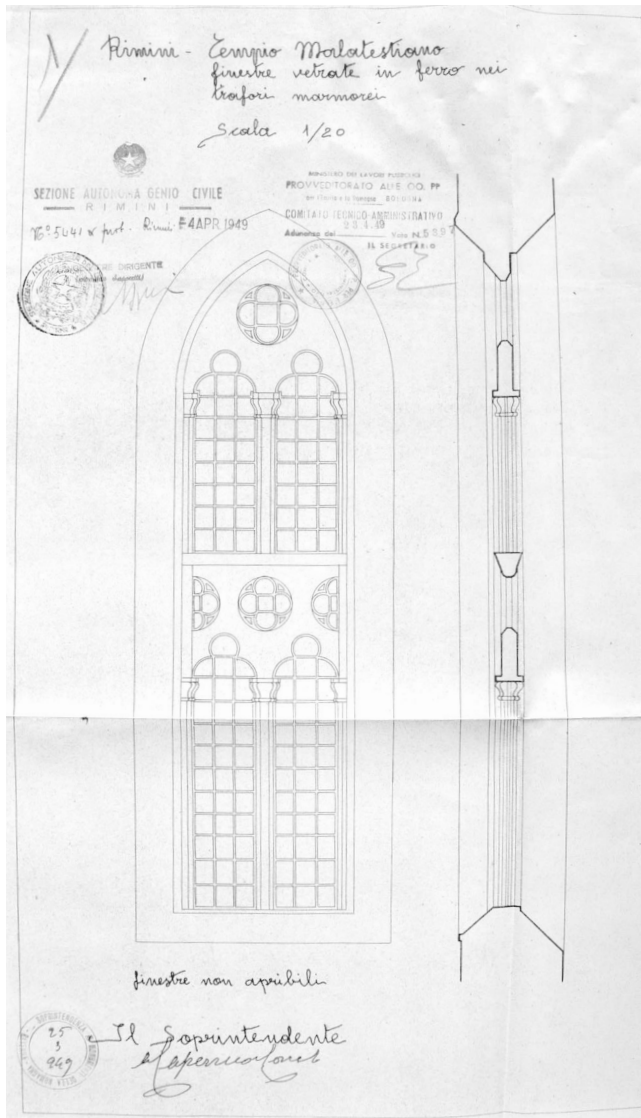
| Progetto dei nuovi infissi con profilo artistico
